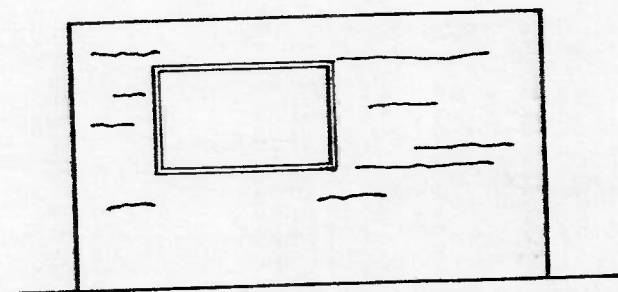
Fissuras horizontais no revestimento provocadas pela expansão da argamassa de assentamento
